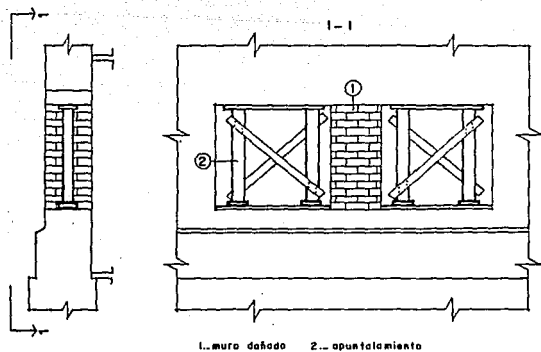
Apuntalamiento de aberturas con soportes de madera (Ref.15)
